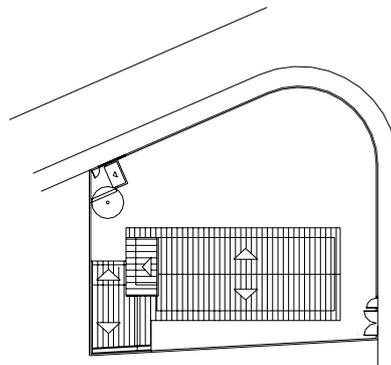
Planta da Cobertura, sem escala. Fonte: CIESZO.
